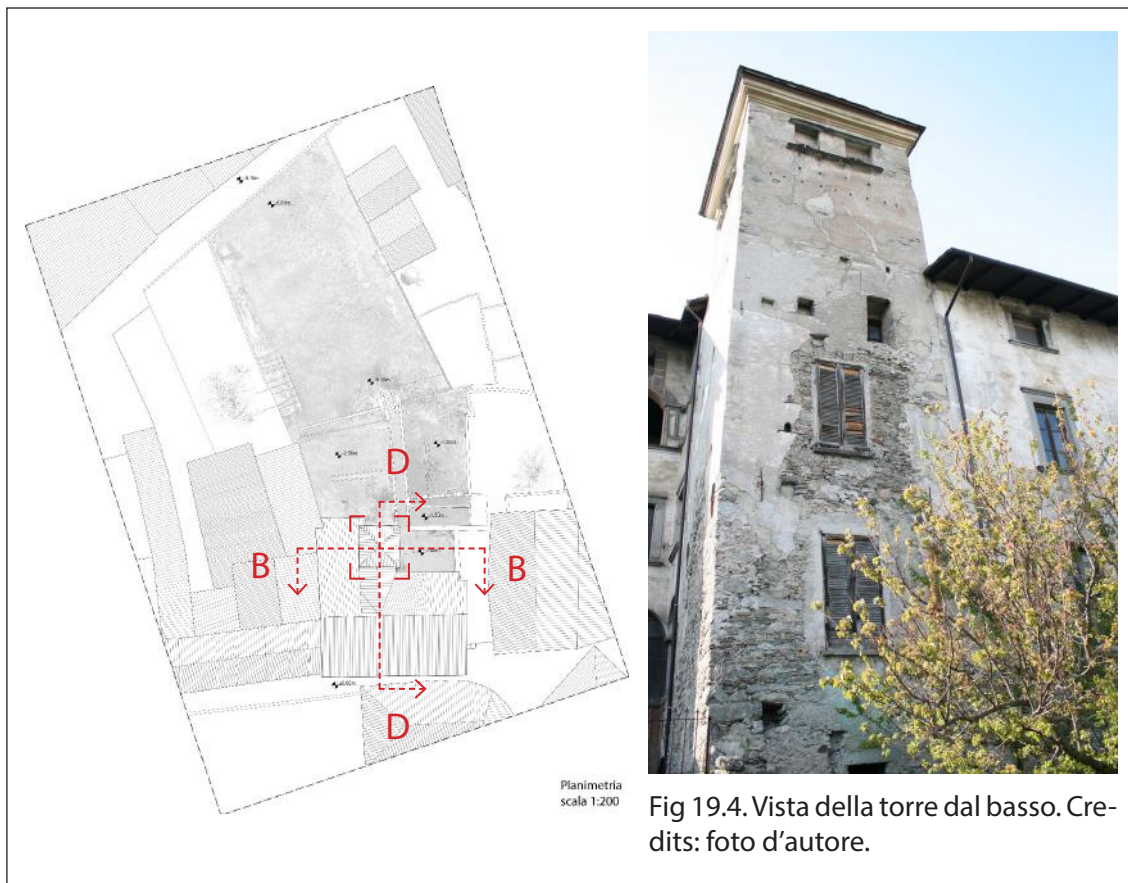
Vista della torre dal basso. Credits: foto d'autore.
